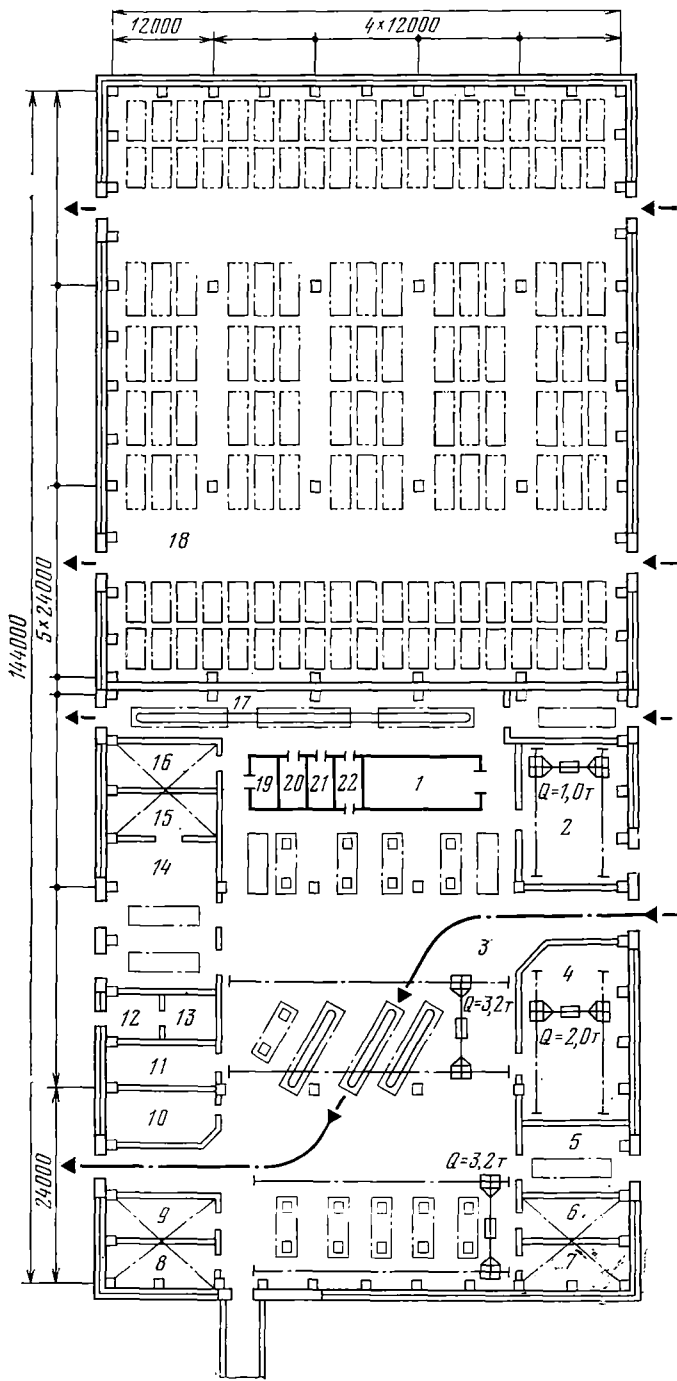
Планировка производственного корпуса АТП на 300 грузовых автомобилей с частично закрытой стоянкой
